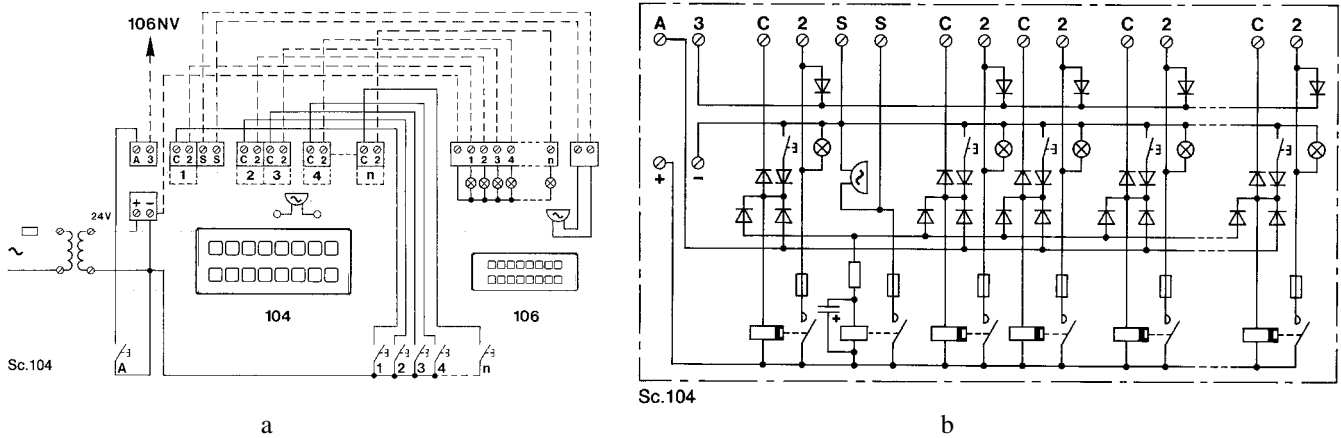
Quadro indicatore luminoso (art. 104): a) Schema di collegamento multifilare - b) Schema elettrico interno (LT Terraneo).
